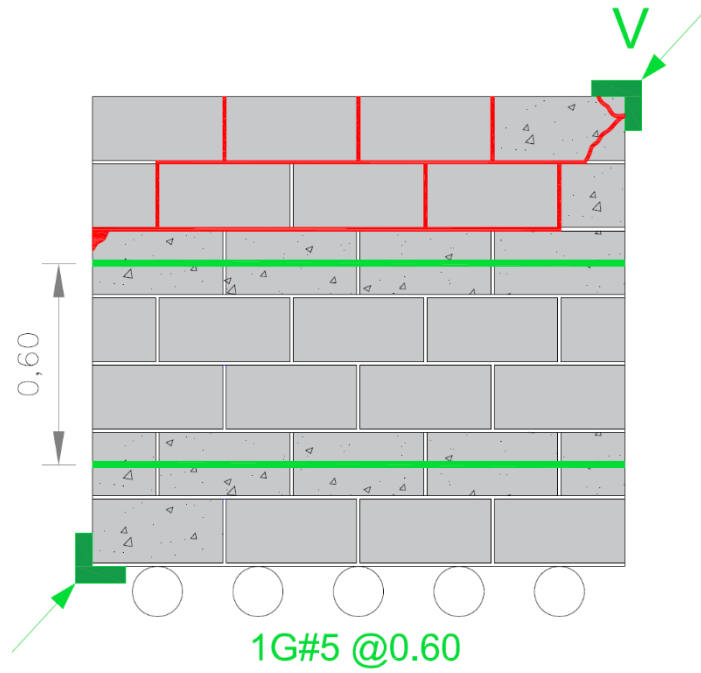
Fisuración y modo de falla del muro MD-1#5/60
